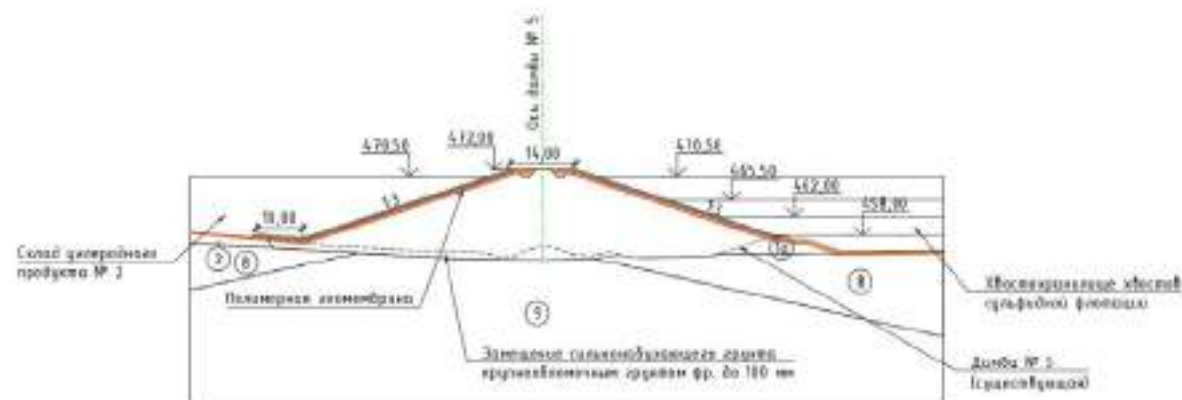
Расчетное сечение 3-3 по дамбе № 5
